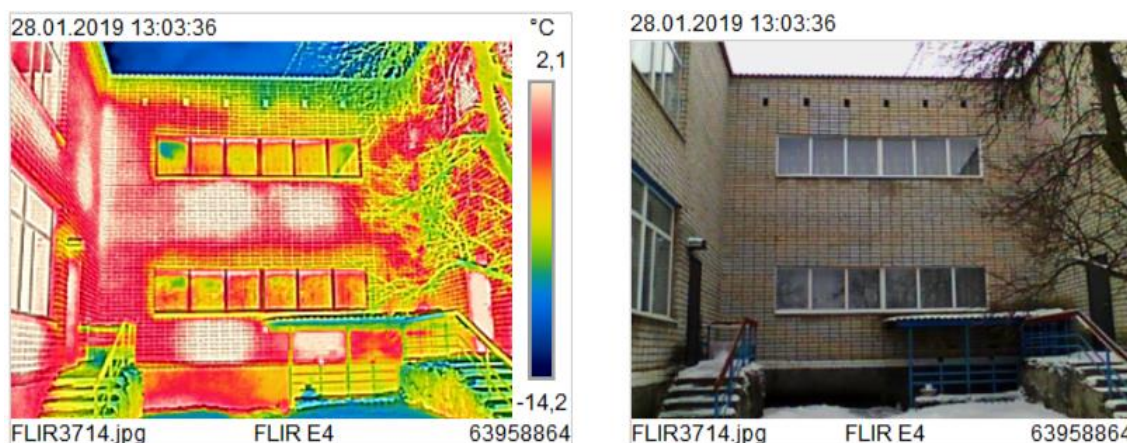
Термограма фрагменту фасаду будівлі ззовні
